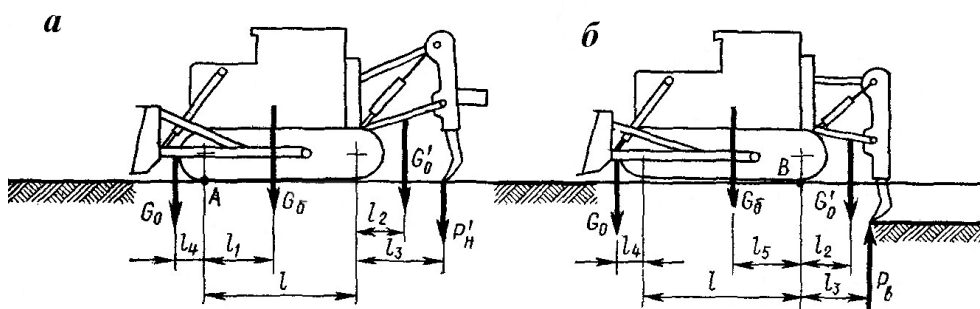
Схемы к расчету усилий на зубьях рыхлителя: а – при заглублении; б – при подъеме
